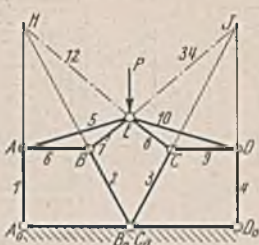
Aus dem Scheibenfachwerk der Abb. 1 durch Fachwerksausführung der Scheiben entwickeltes Stabfachwerk.
